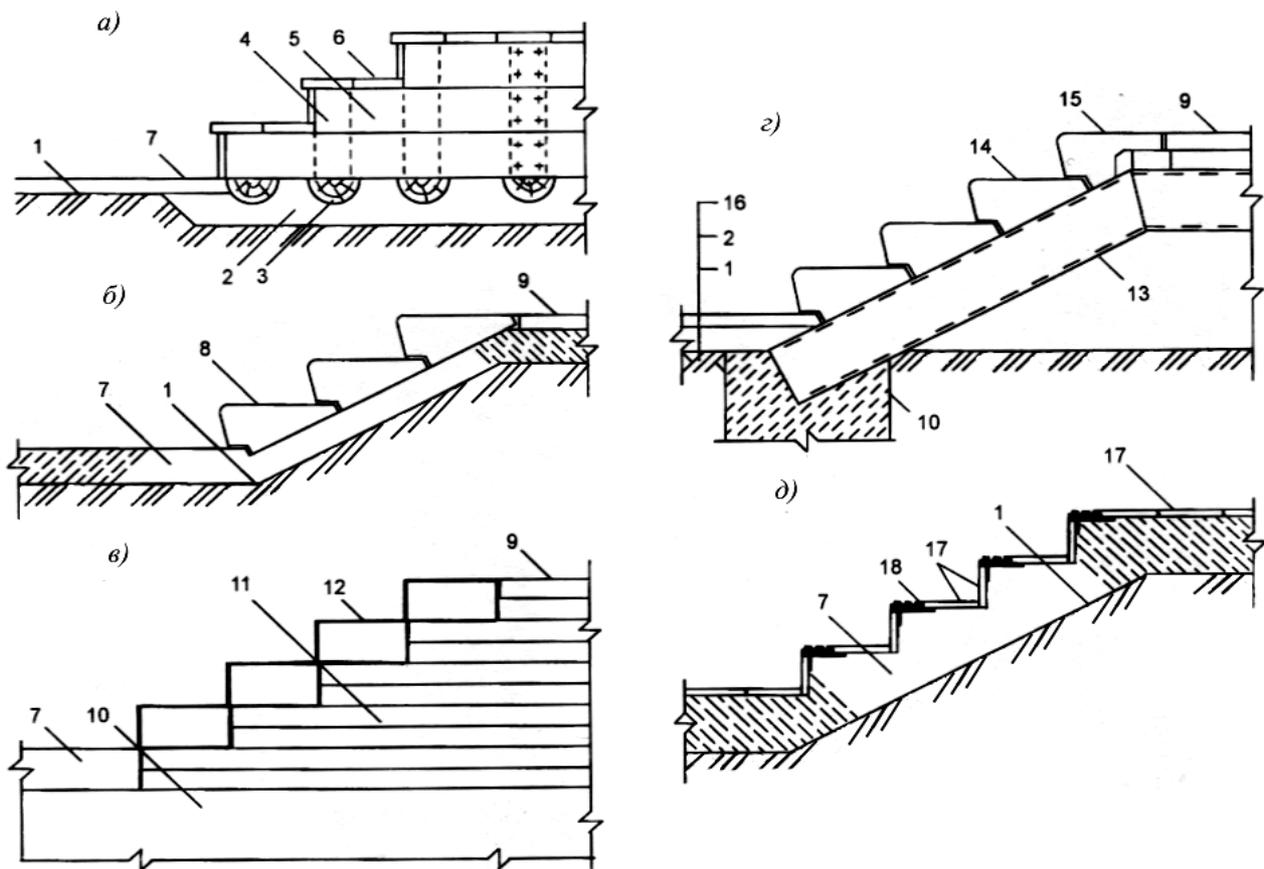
Планировочные схемы входных лестниц жилых зданий
